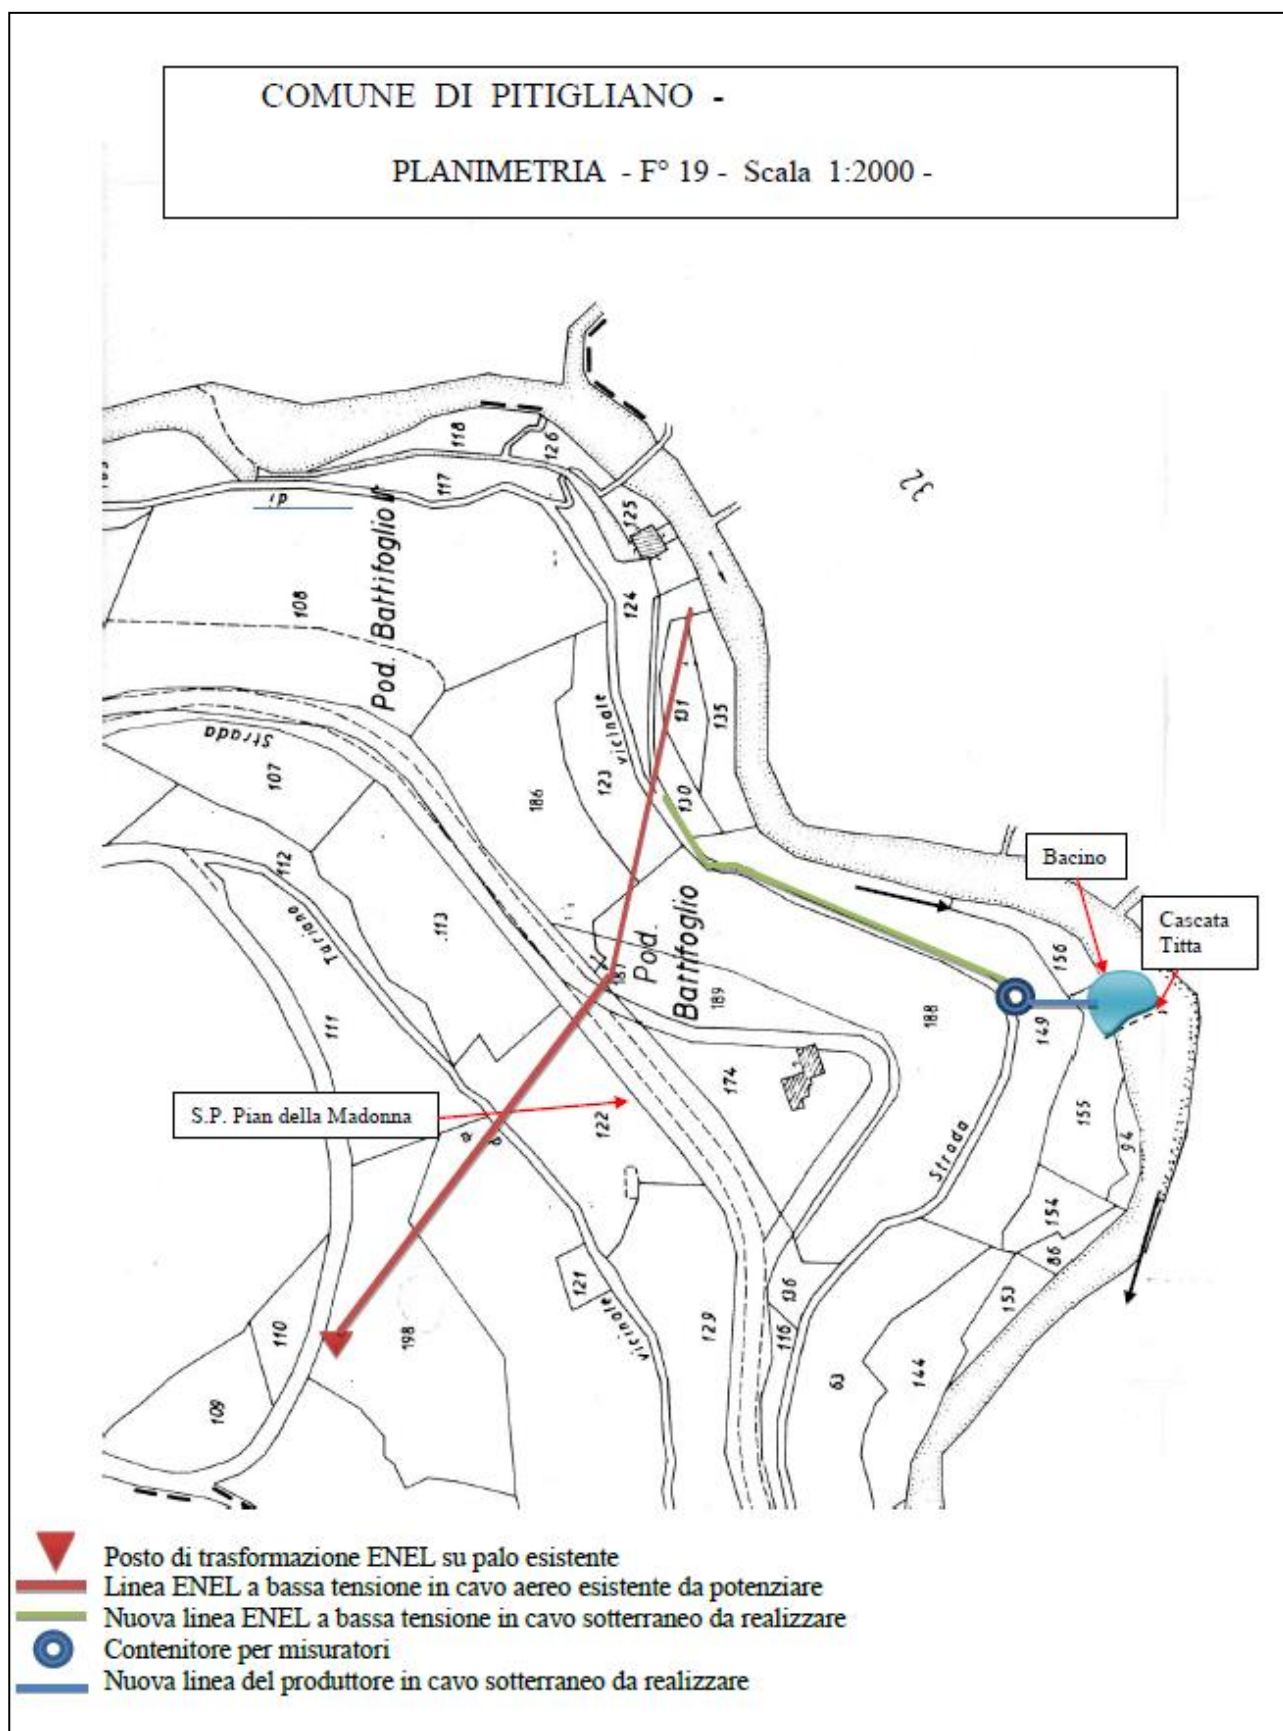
Planimetria con le opere di E-Distribuzione e le opere private
